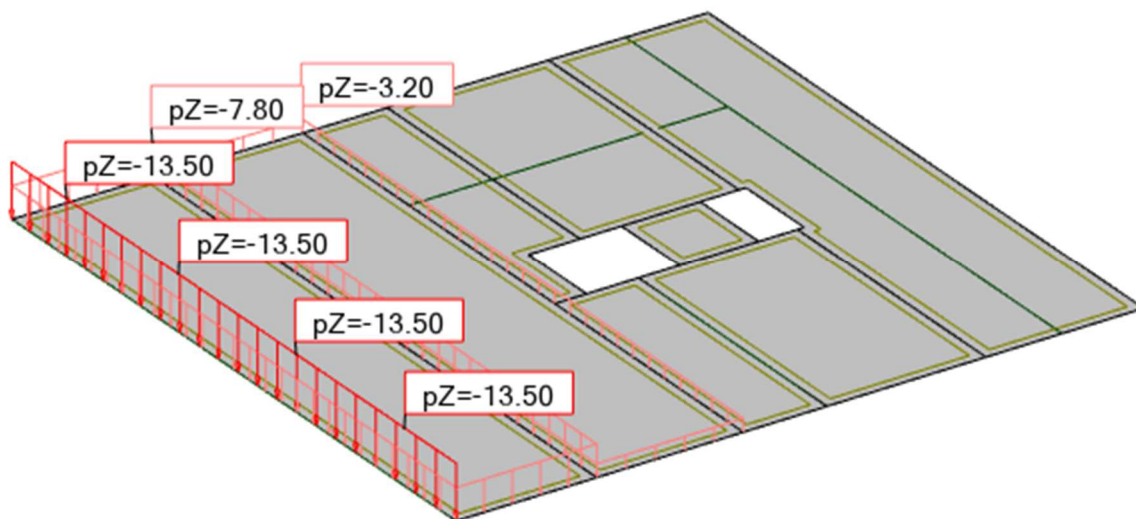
Exemplo de cargas exteriores atuantes na laje
